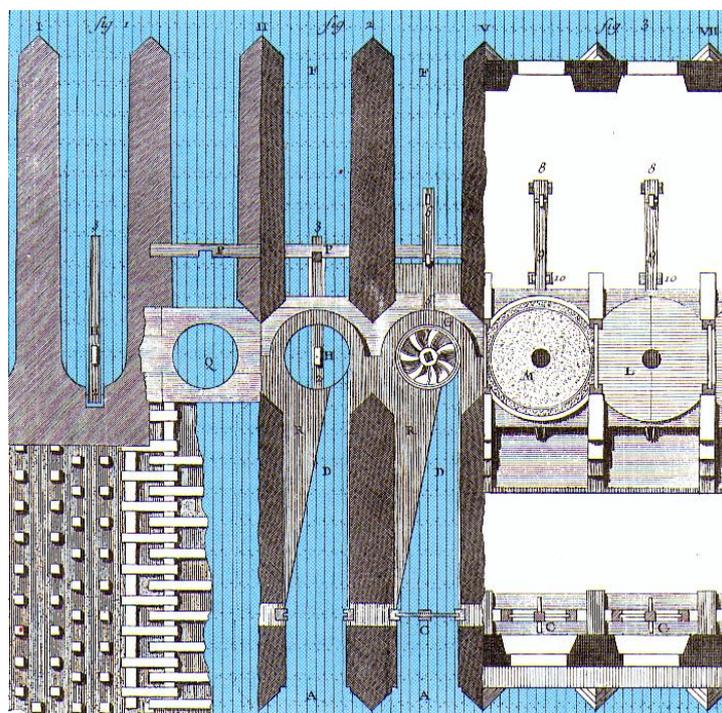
Planta de un molino de regolfo, donde se aprecia el trazado trapezoidal de los canales y la ubicación de pozuelos, rodetes y piedras de moler.
